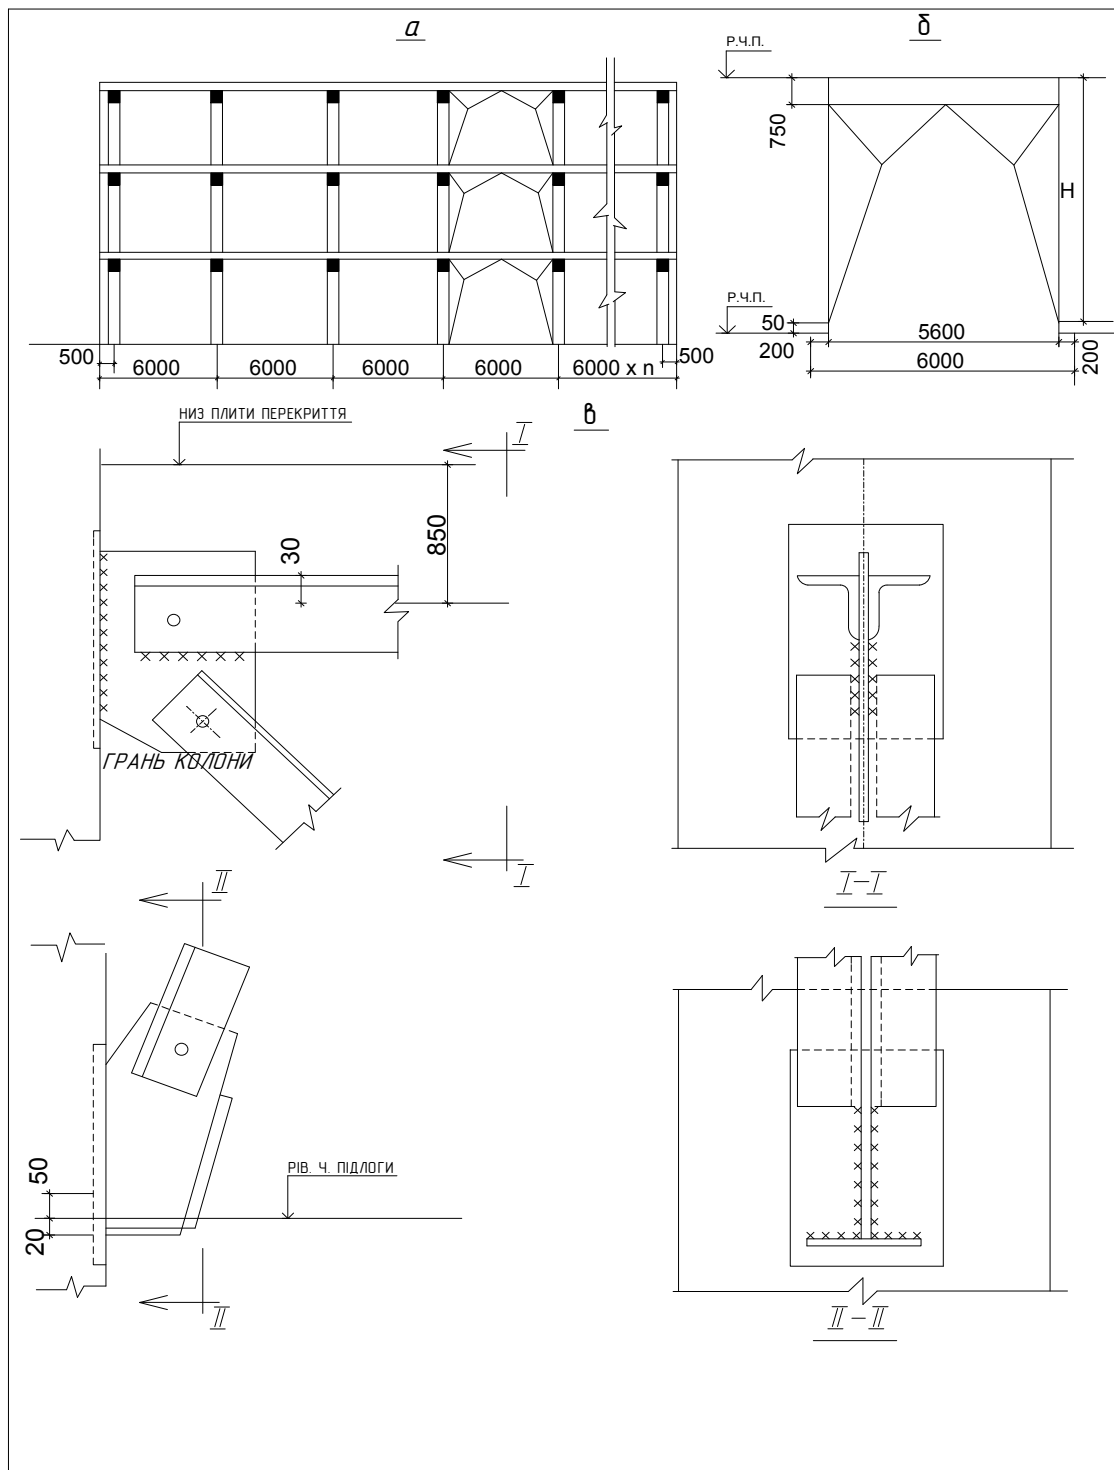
Вертикальні зв'язки: а – схема повздовжніх зв'язків багатоповерхової промислової будівлі; б – конструктивна схема зв'язку; в – вузли кріплення повздовжніх зв'язків до колон
